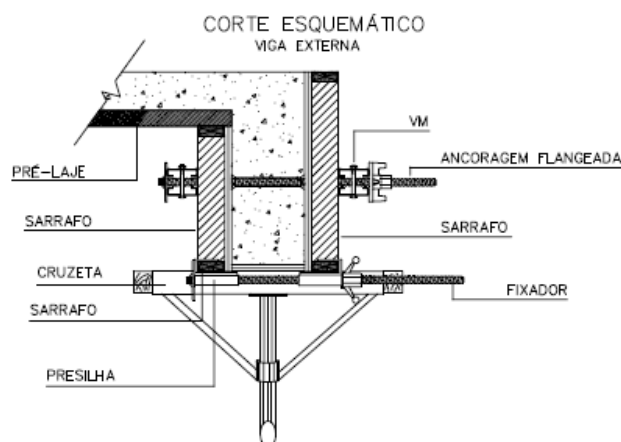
corte esquemático do apoio da pré-laje no painel interno das vigas externas⁵
